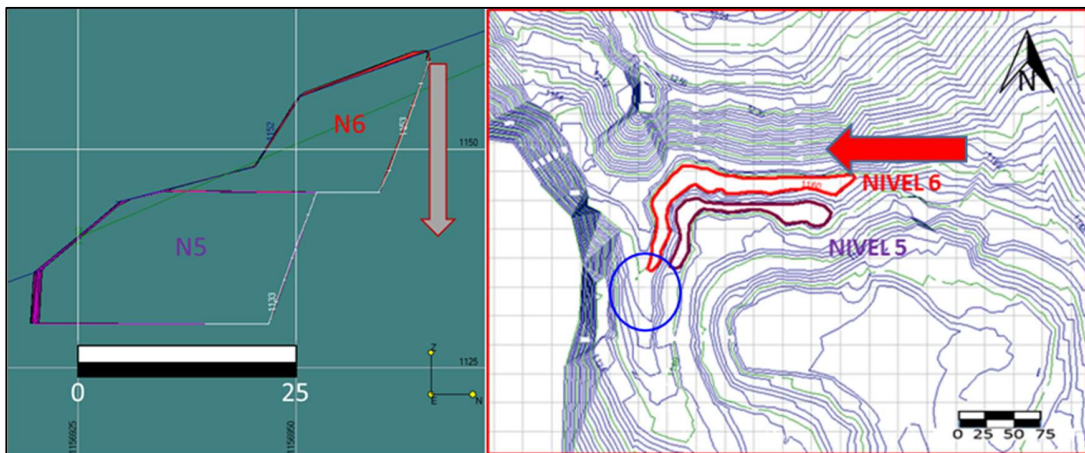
Vista de perfil secuencia de extracción de los niveles 5 y 6.
